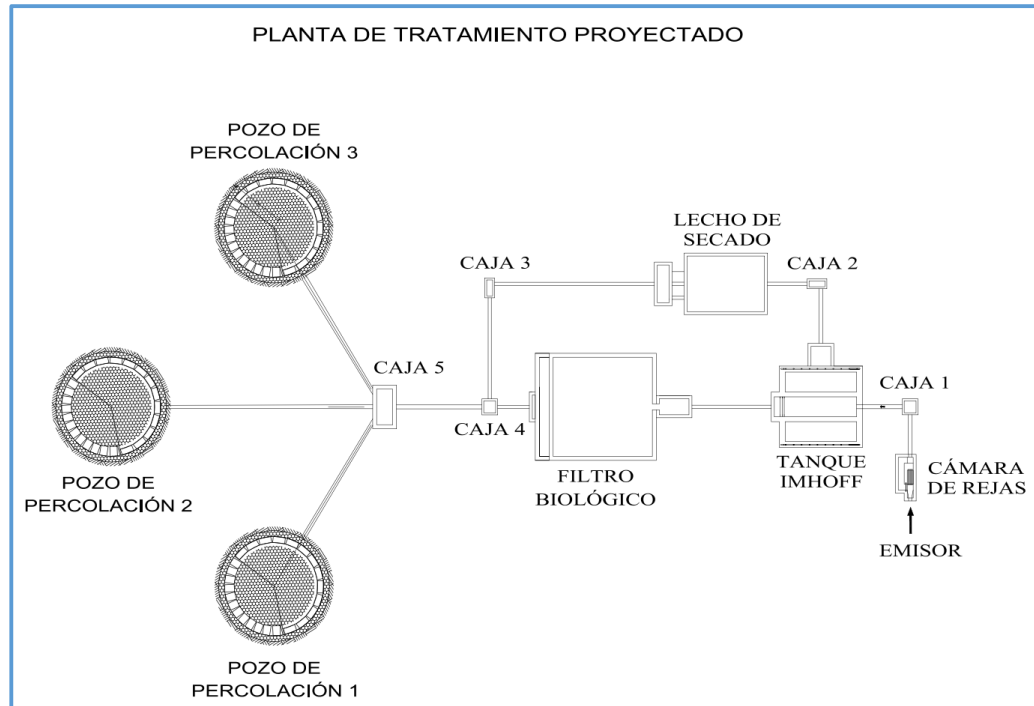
Planta general de la planta de tratamiento de aguas residuales
